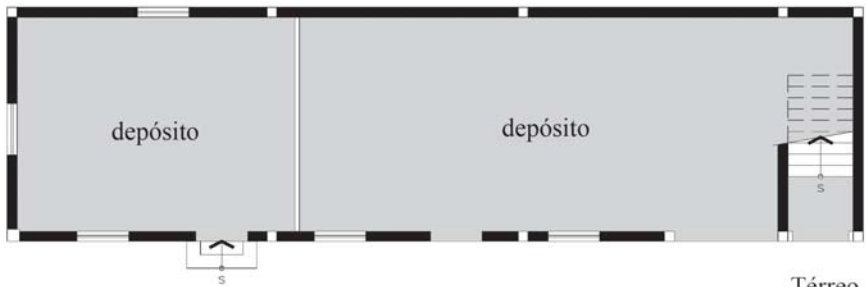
(abaixo) - Planta do casarão da fazenda São Gilberto, antiga fazenda Santa Bárbara, Sales Oliveira. Desenho: M. Rosada. Lev. V. Benincasa e L. M. da S. M. Rosa.
